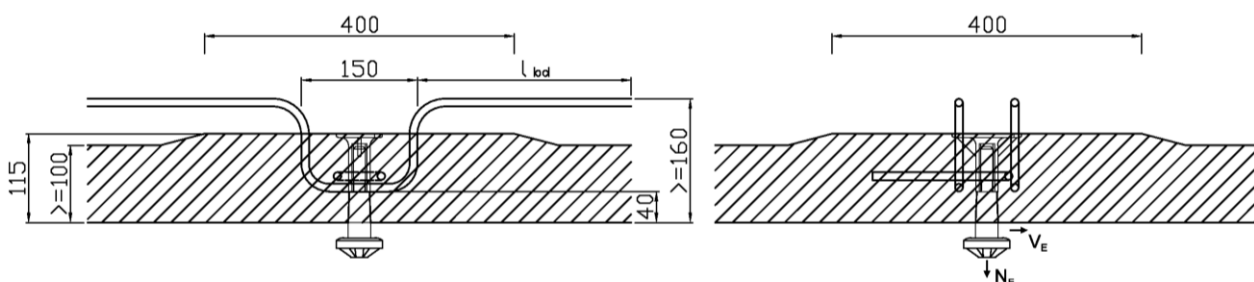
Einbauzustand im Fertigteil vor der Ortbetonergänzung
